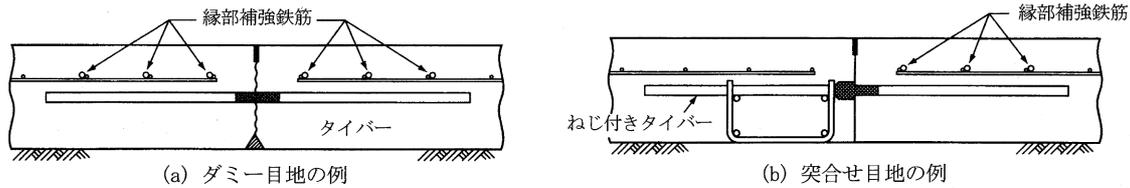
横収縮目地の施工例 (単位: mm)⁵⁾
